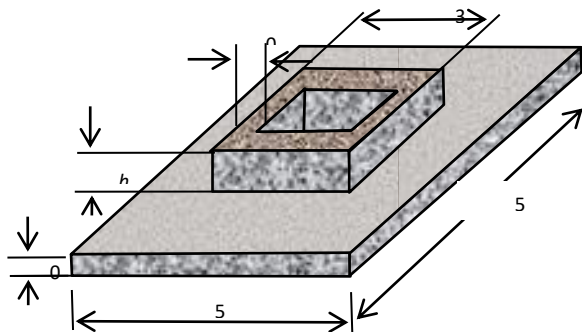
Прямоугольная железобетонная плита с отверстием, подкрепленным ребрами
